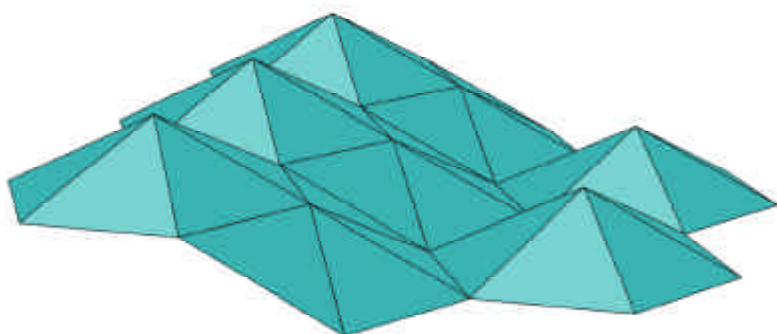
Kvadratisk uppbyggda toppar i plan och sidovy. Dessa två exempel har en geometri som medger att takkonstruktionen ledas så att viss balkverkan erhålles.
